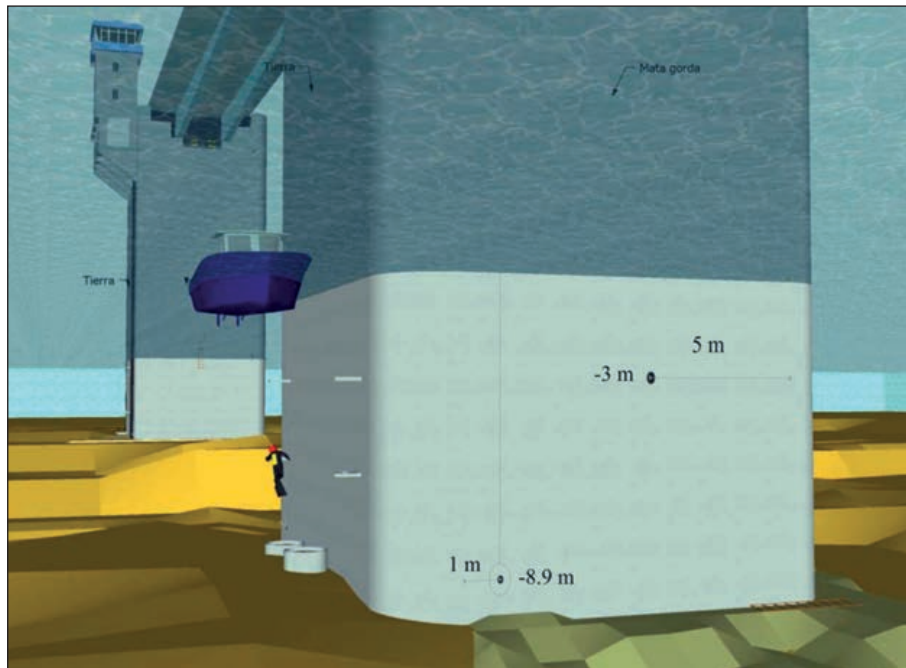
CROQUIS DE UNA INSPECCIÓN SUBACUÁTICA.
